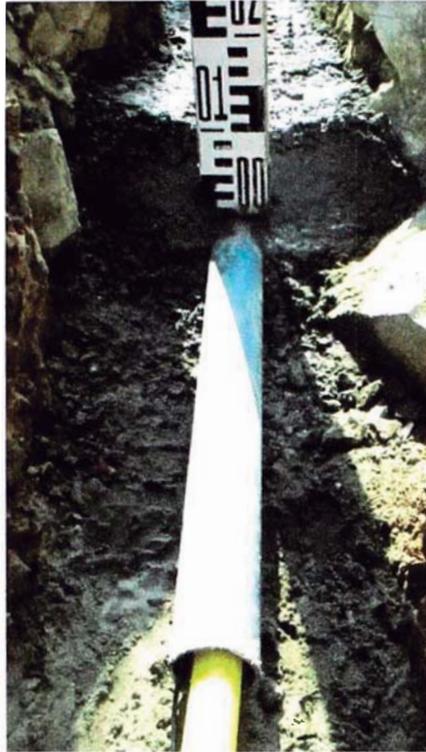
Protección mecánica, con tubo de pvc y embebido en concreto.
